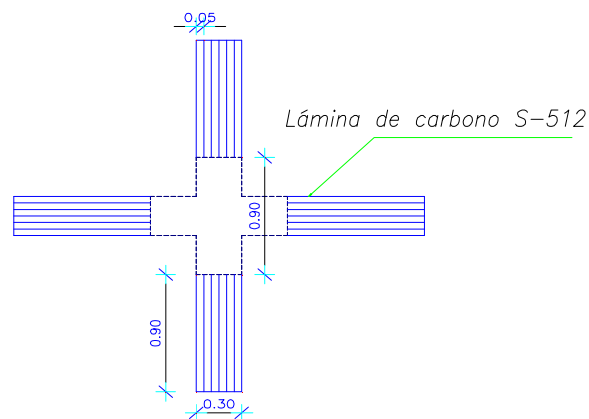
Detalle refuerzo láminas de carbono en planta
